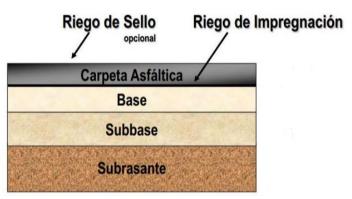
Esquema de la Estructura de un Pavimento Flexible Fuente: Manual de procesos Constructivos para Pavimentos de baja intensidad del tráfico de el Salvador utilizando concreto hidráulico simple y emulsiones asfálticas.
